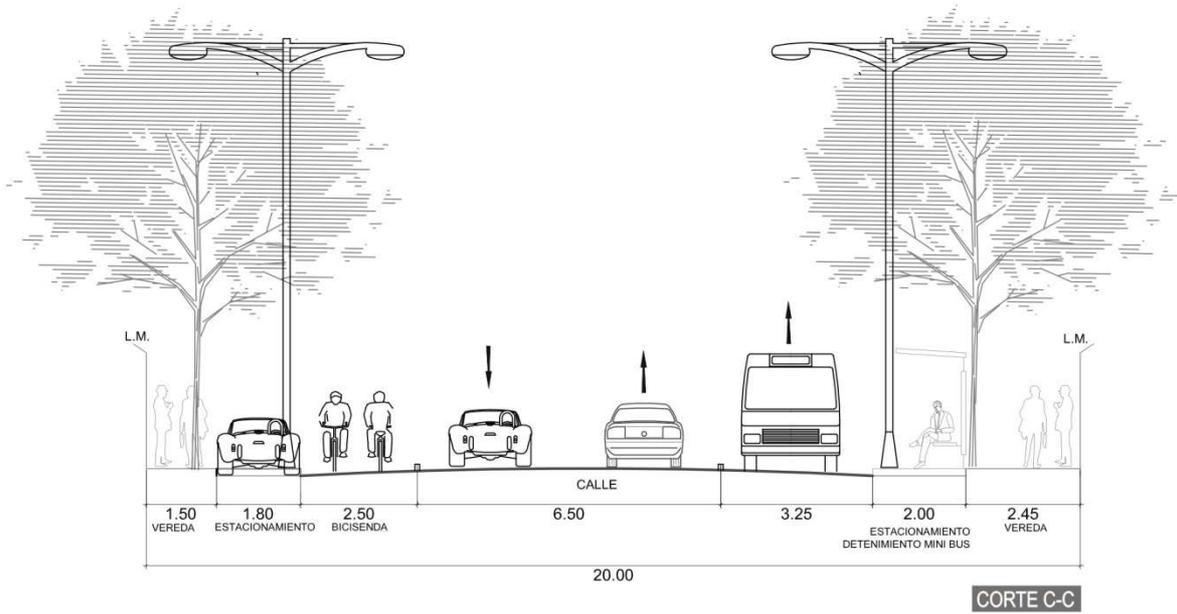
Modelo Espacial: Plano de ubicación y corte C-C ilustrando la propuesta de desarrollo urbano y apertura de nuevas calles en el Área Central.
